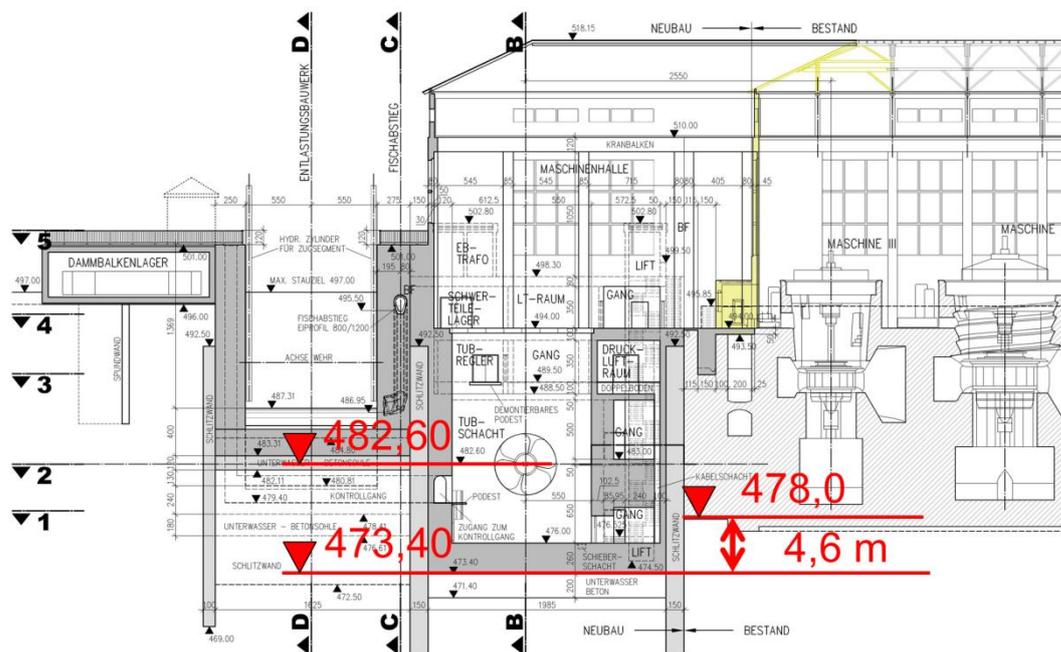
Ausführungsvariante Kraftwerk Kirchbichl 2 und Entlastungsbauwerk
